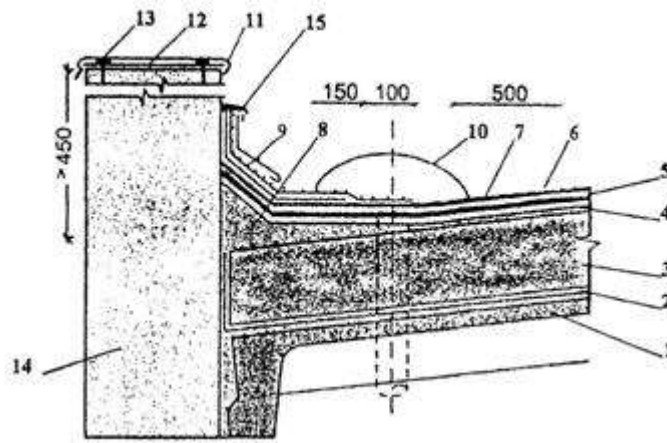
Примыкание кровли к парапету высотой более 450мм
